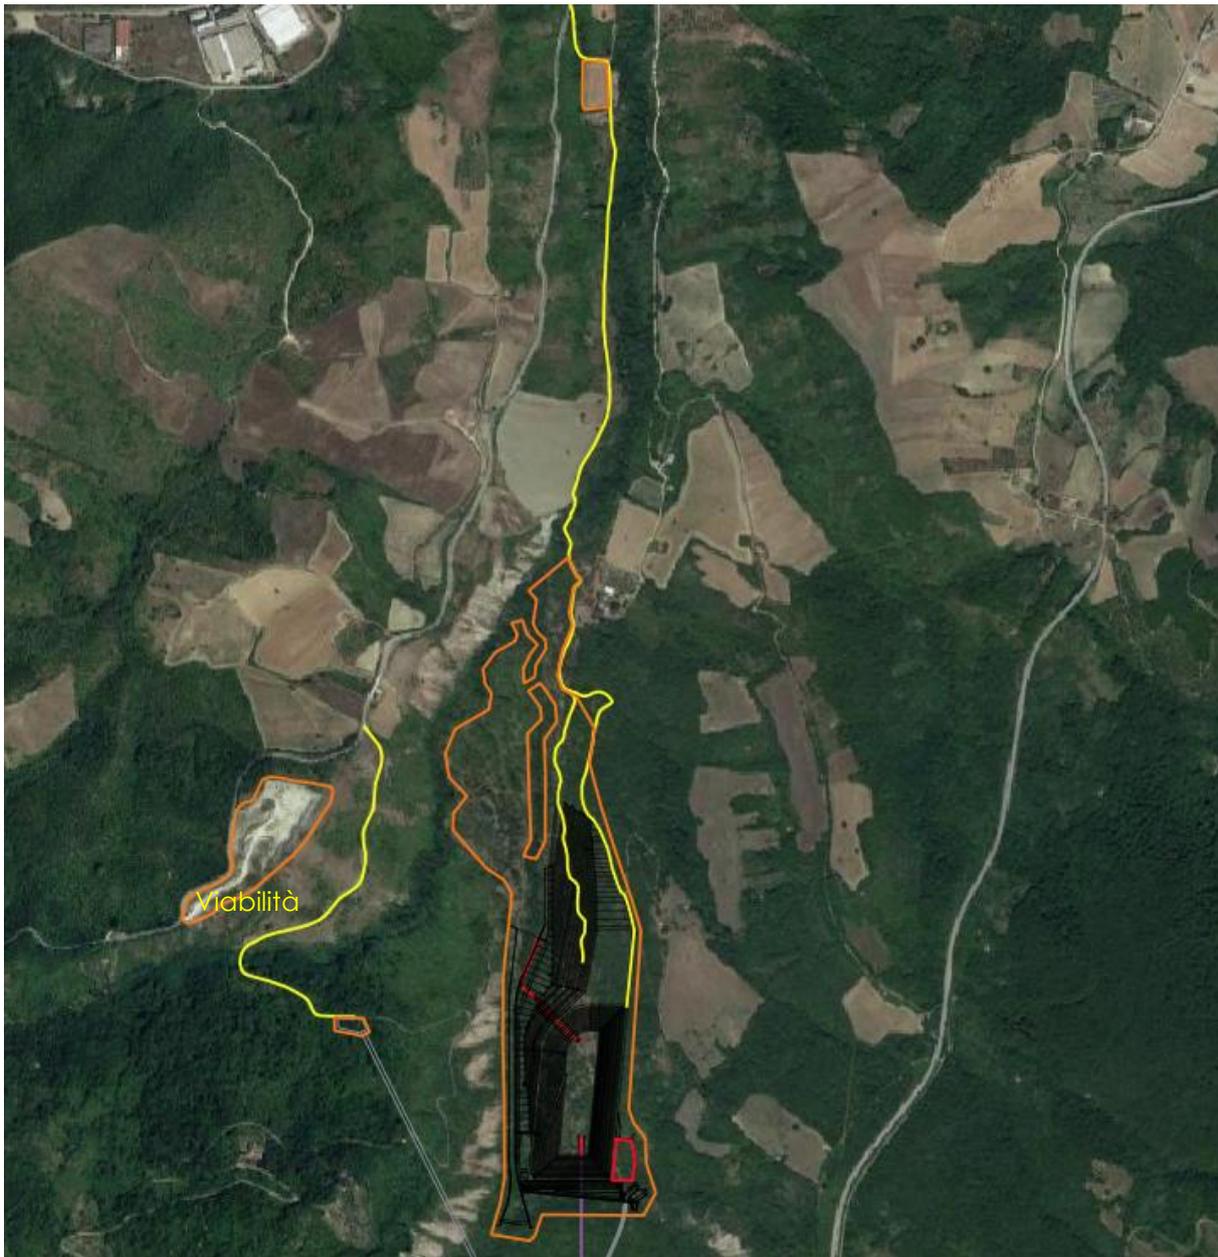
Cantiere Bacino di Valle (Perimetro Arancione)
